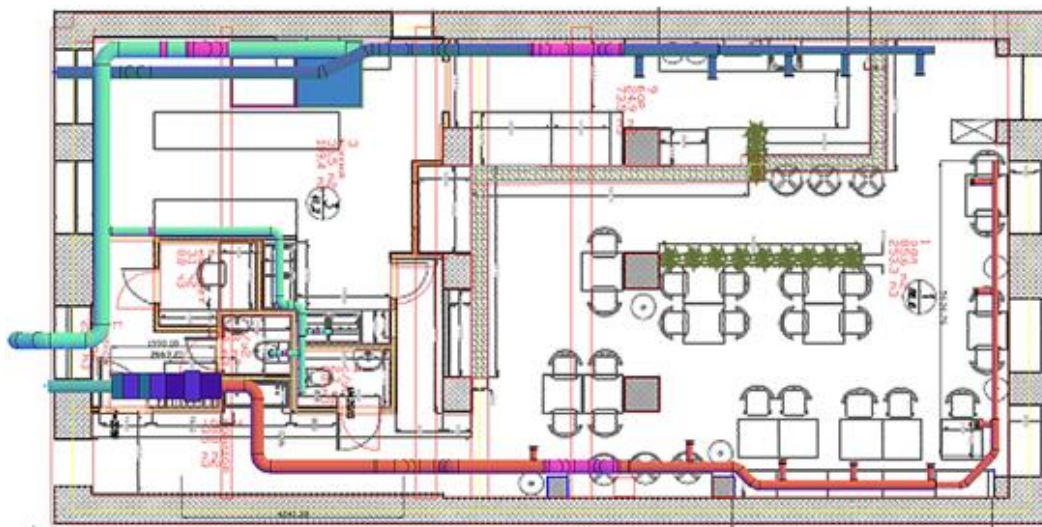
Спроектированный план системы вентиляции ресторана
